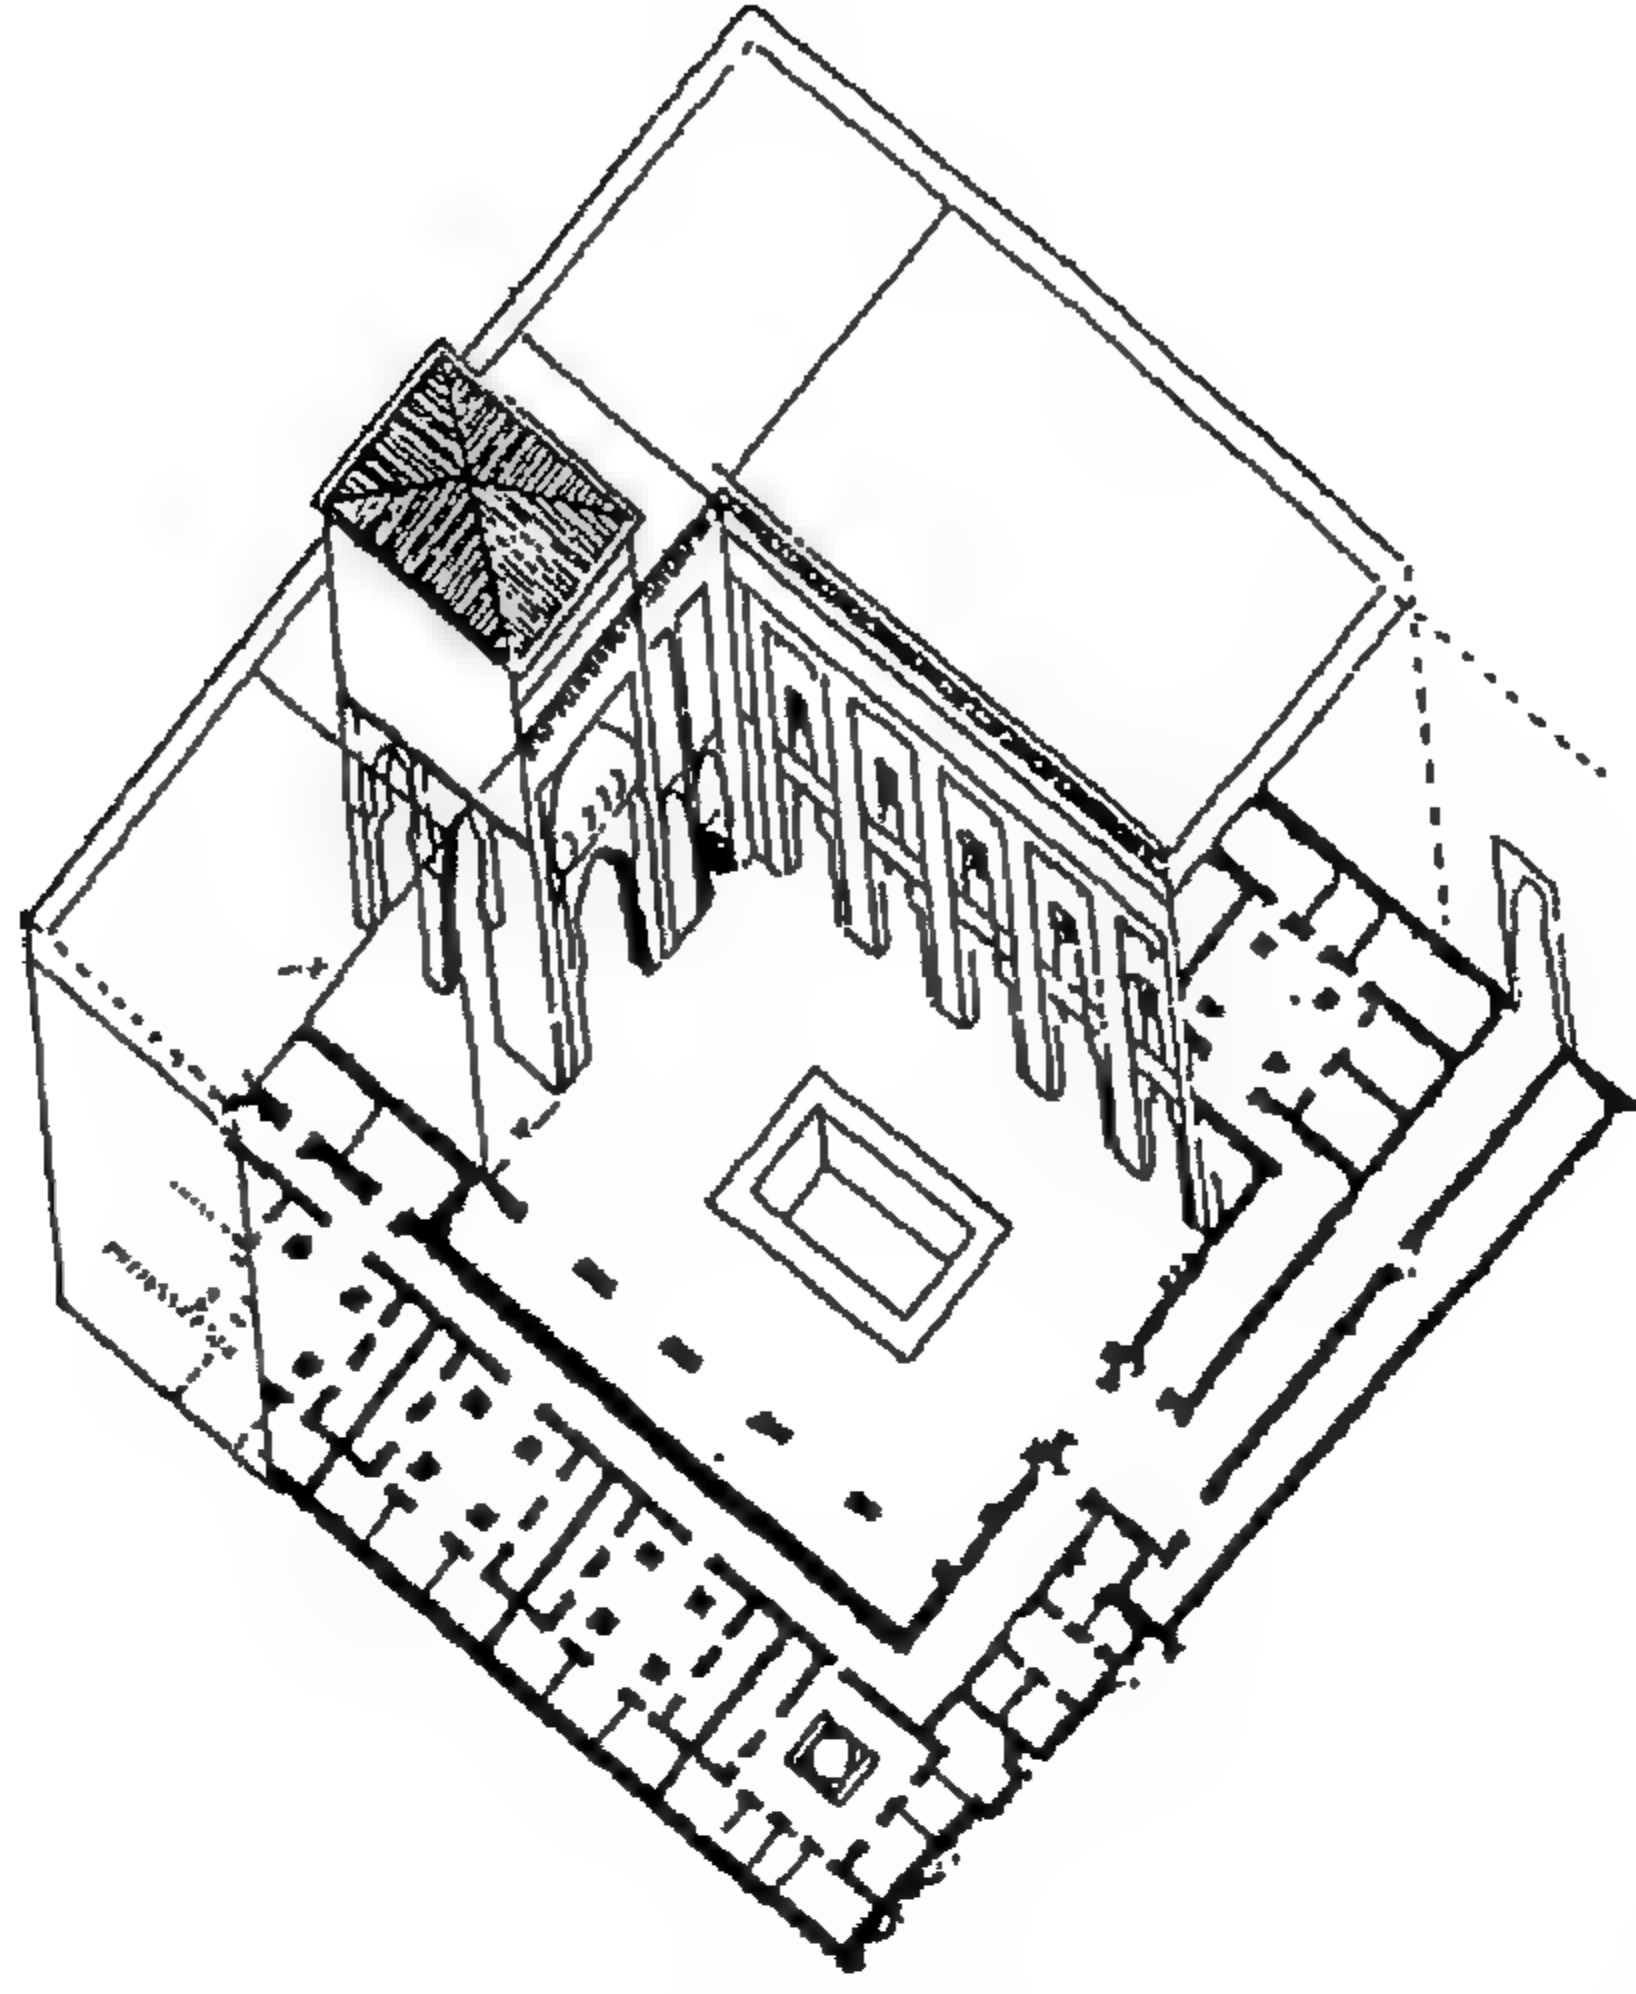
مسقط أفقي لجامع أحمد باشا القره مانلي بطرابلس الغرب.
